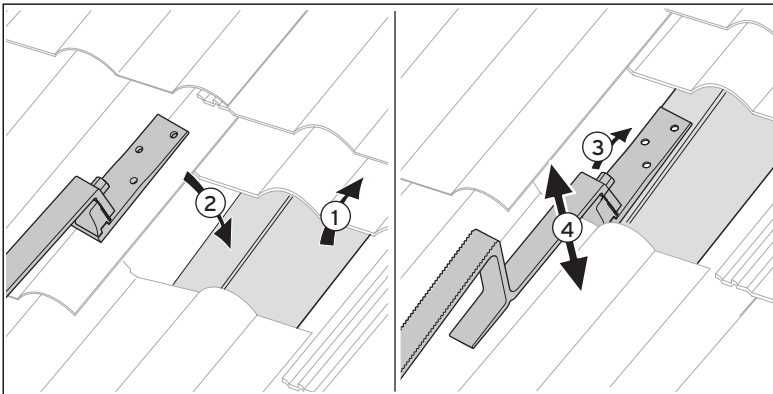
Position des Dachankers Typ P auf dem Dachsparren festlegen
